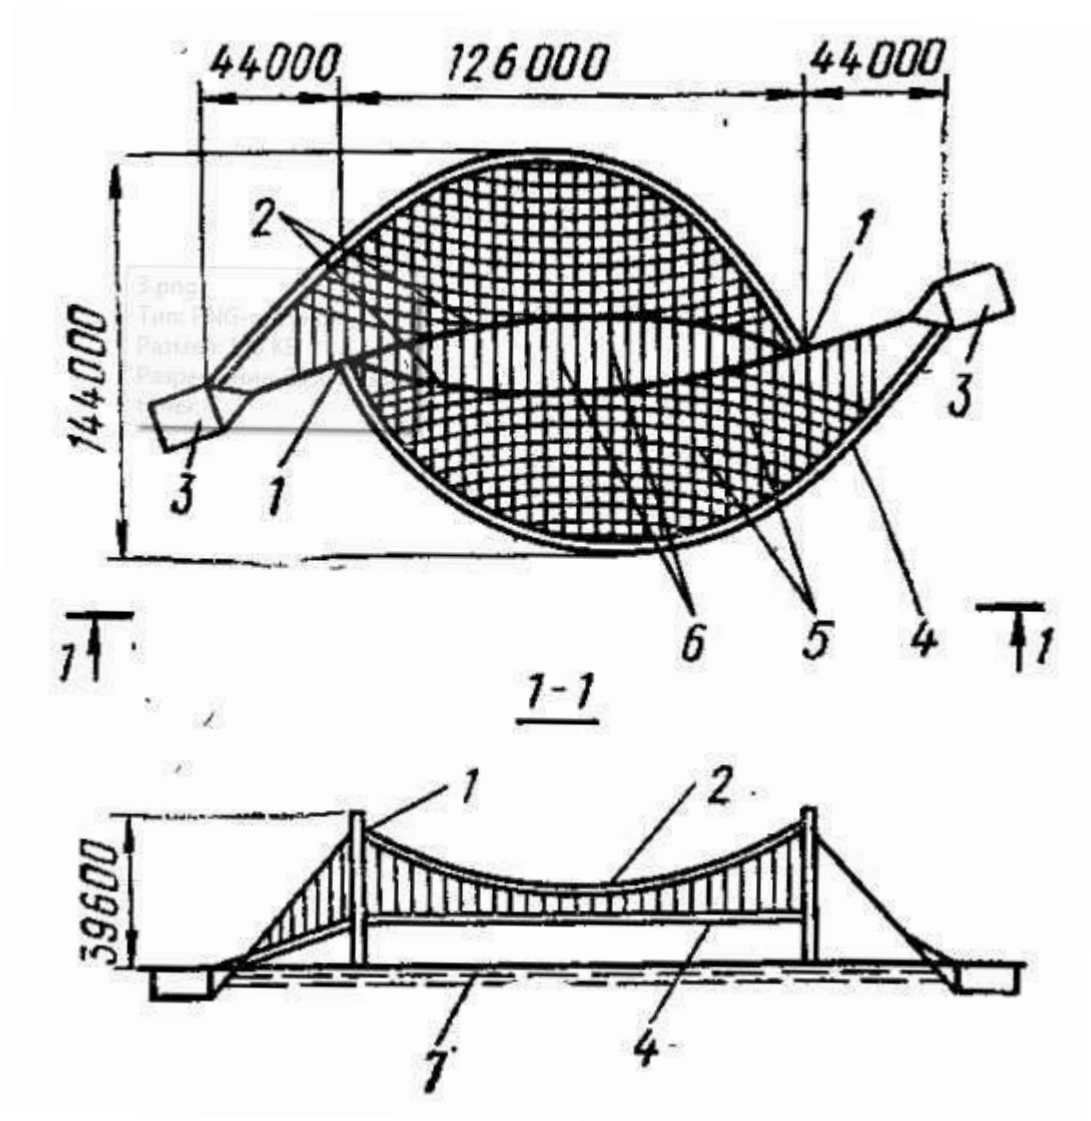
Пример сложного сетчатого покрытия плавательного бассейна олимпийского комплекса в Токио (Япония): 1 – пилоны; 2 – тросы подборы; 3 – анкерные фундаменты; 4 – контурные балки; 5 – вантовые фермы; 6 – связи; 7 – распорные балки
